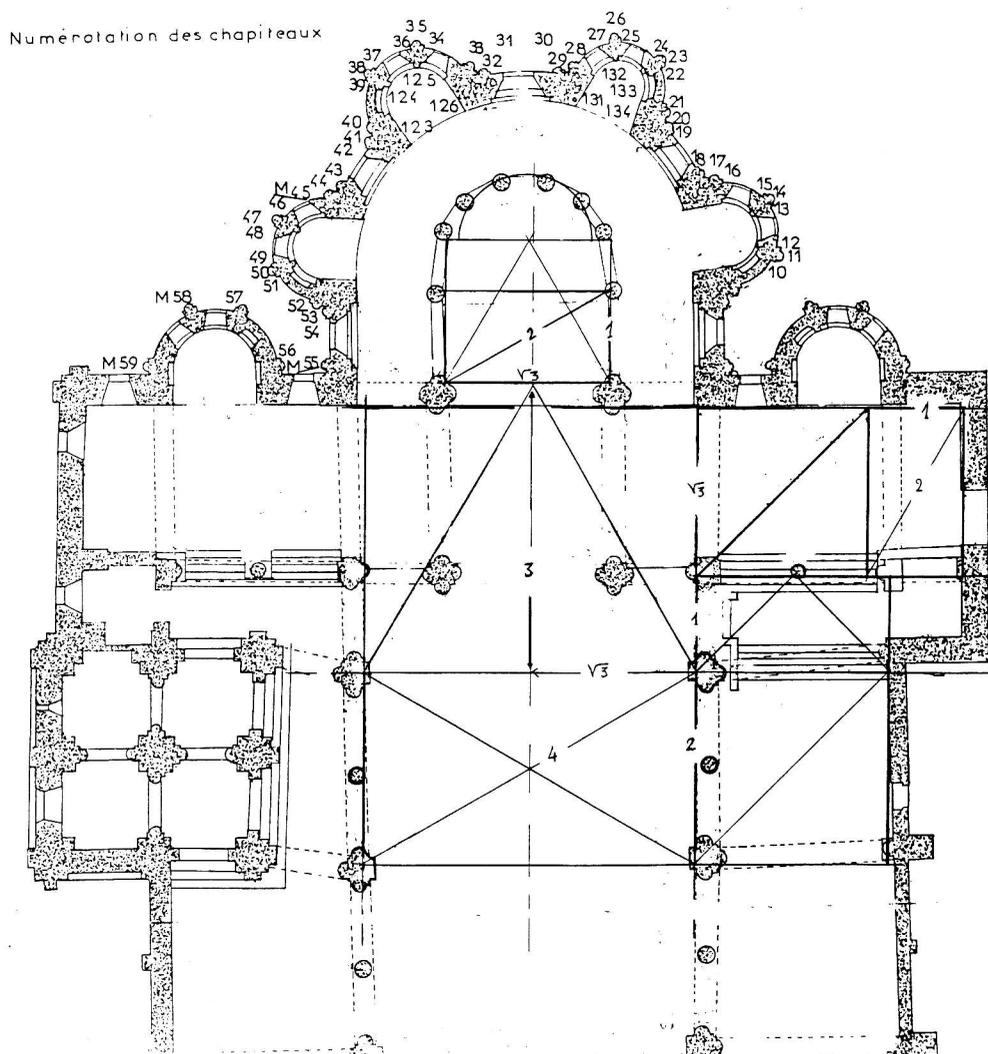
Esquema geométrico en la planta de San Hilario de Poitiers.
